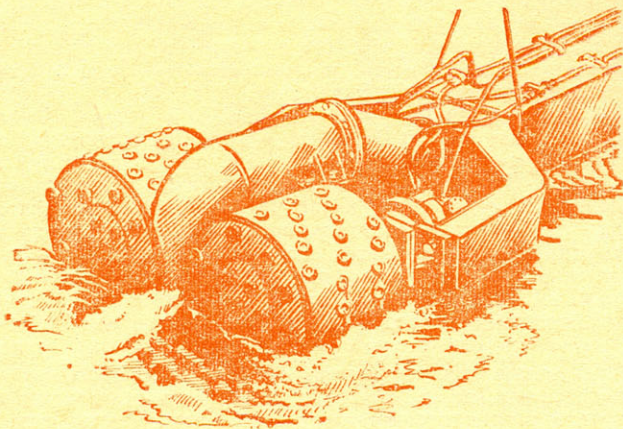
Фрезерный рыхлитель: 1 — корпус всасывающего устройства, 2 — всасывающий трубопровод, 3 — барабан, 4 — режущие устройства.
